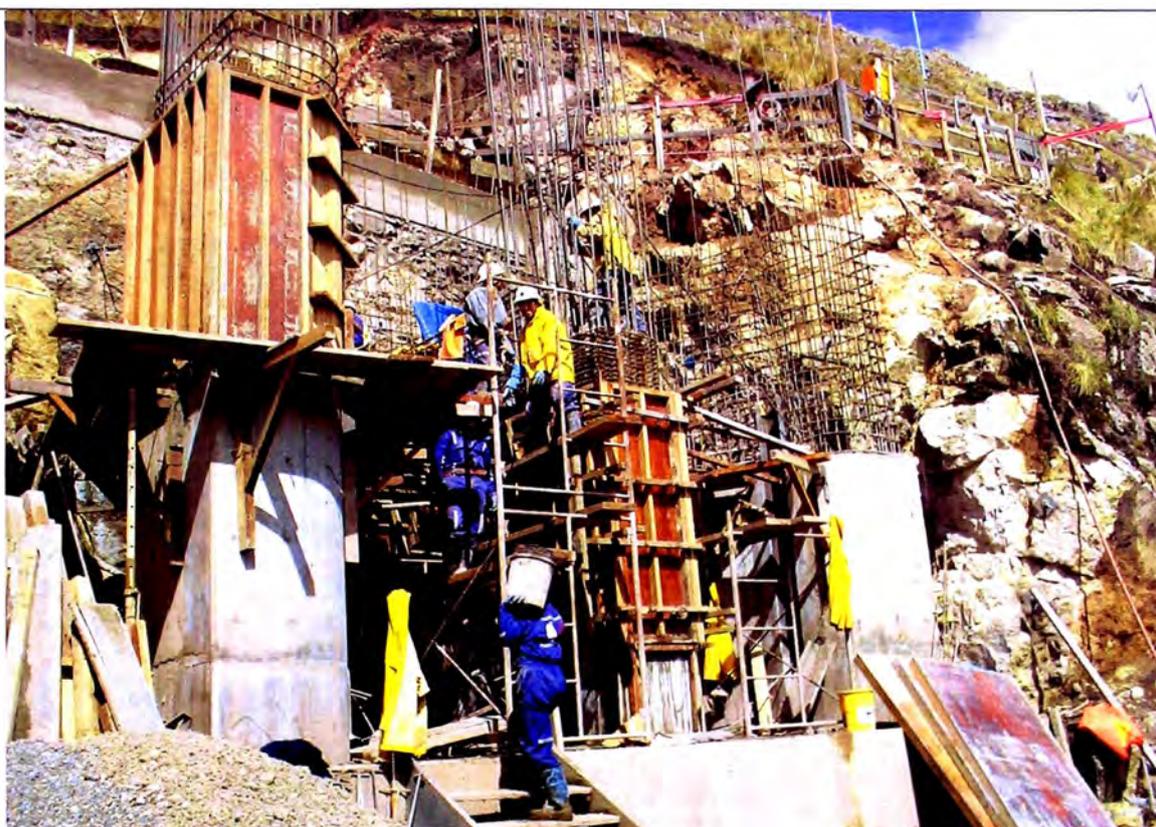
Vaciado manual de concreto en muros Ventana N°13.
